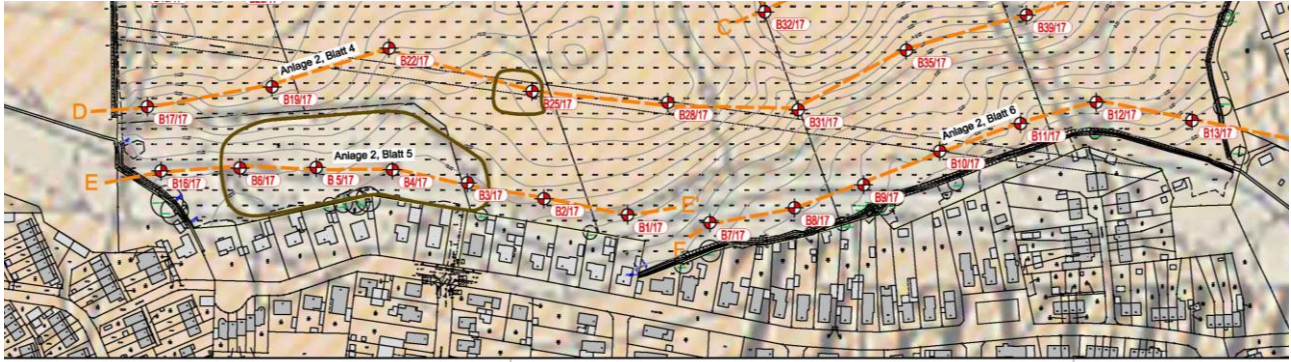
Lageplan mit Untersuchungspunkten, Bereiche mit Torf- Mudden und Torfen im westlichen Plan- gebiet (Lehners + Wittorf 2017)
